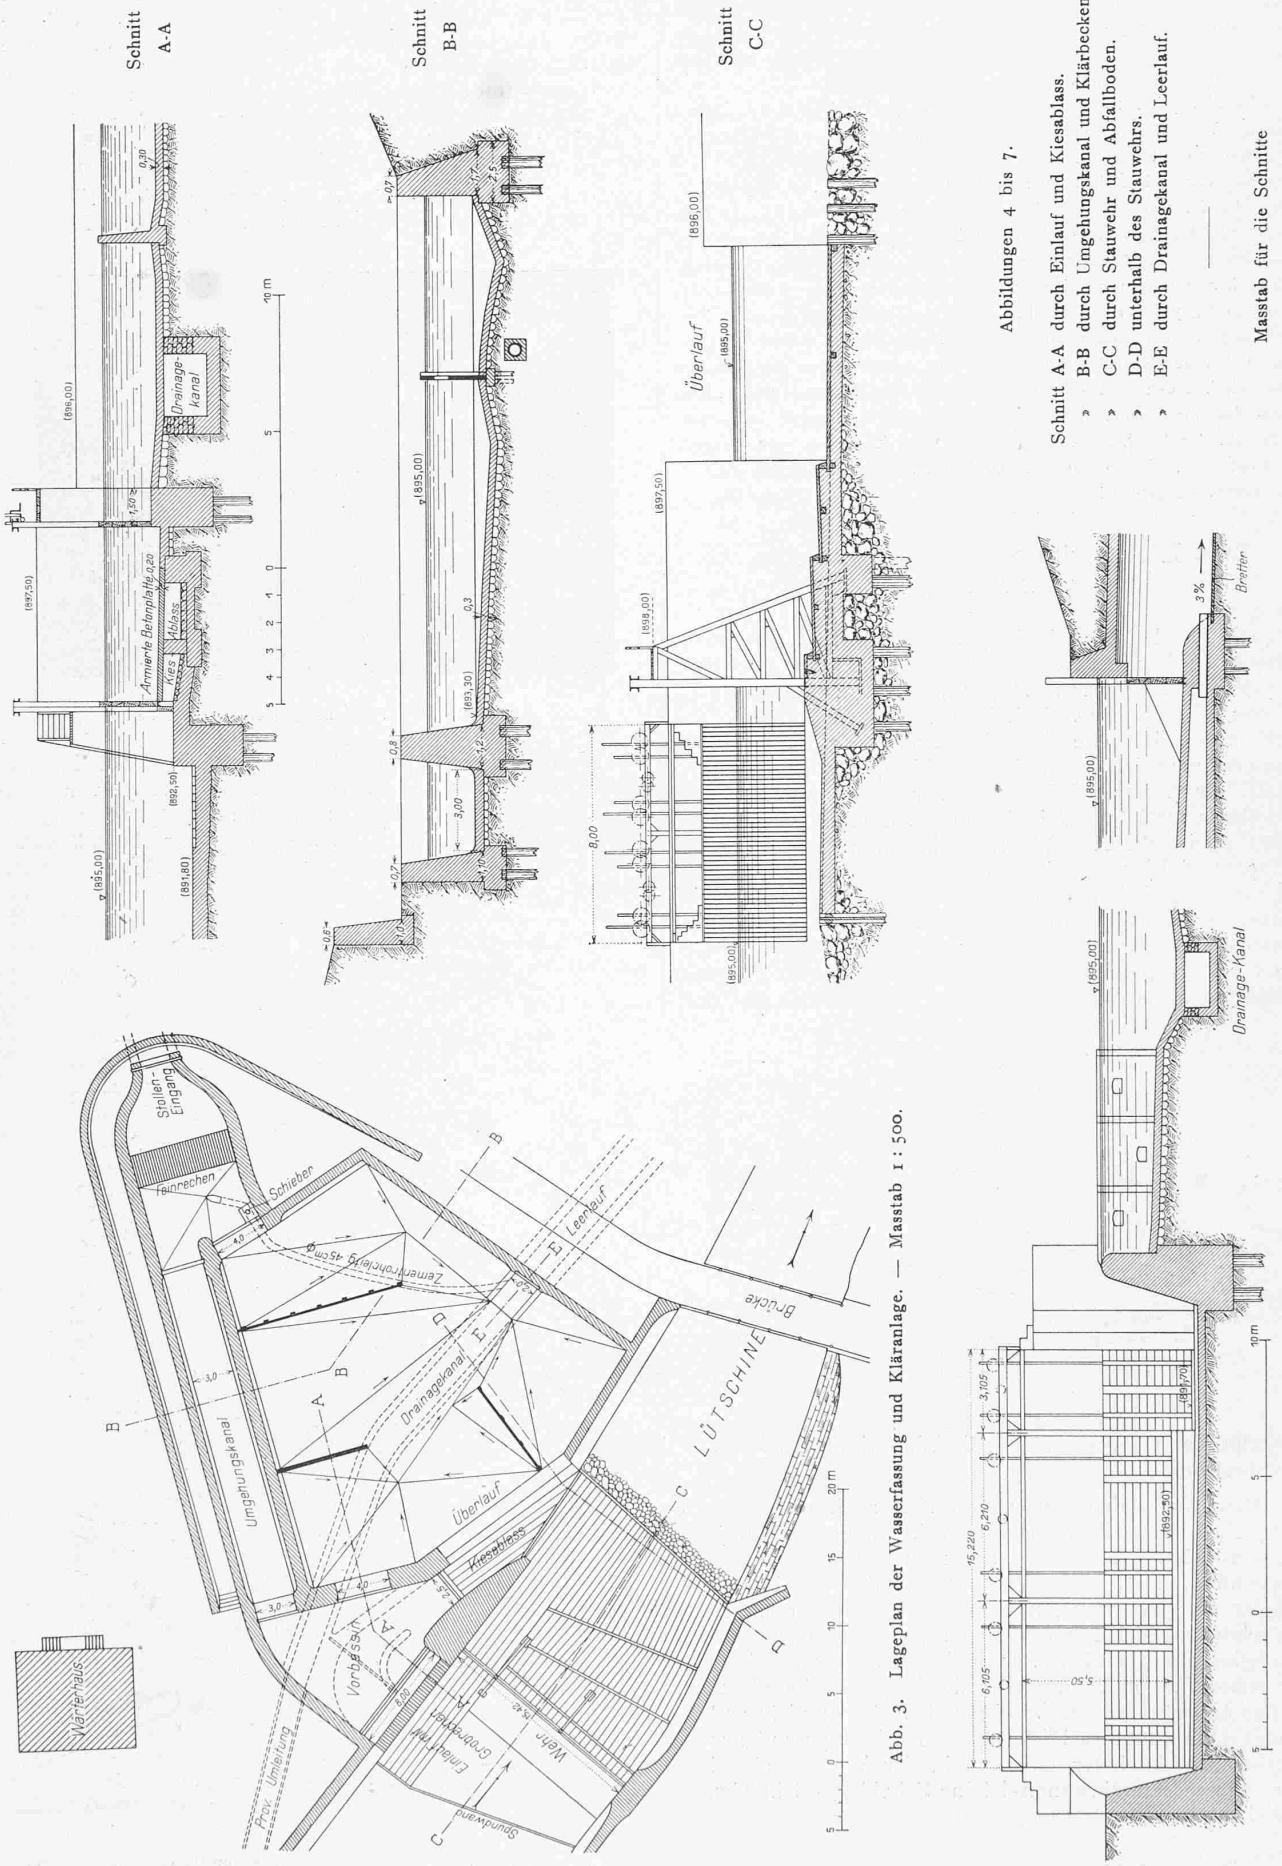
Lageplan der Wasserfassung und Kläranlage. — Masstab 1 : 500.
